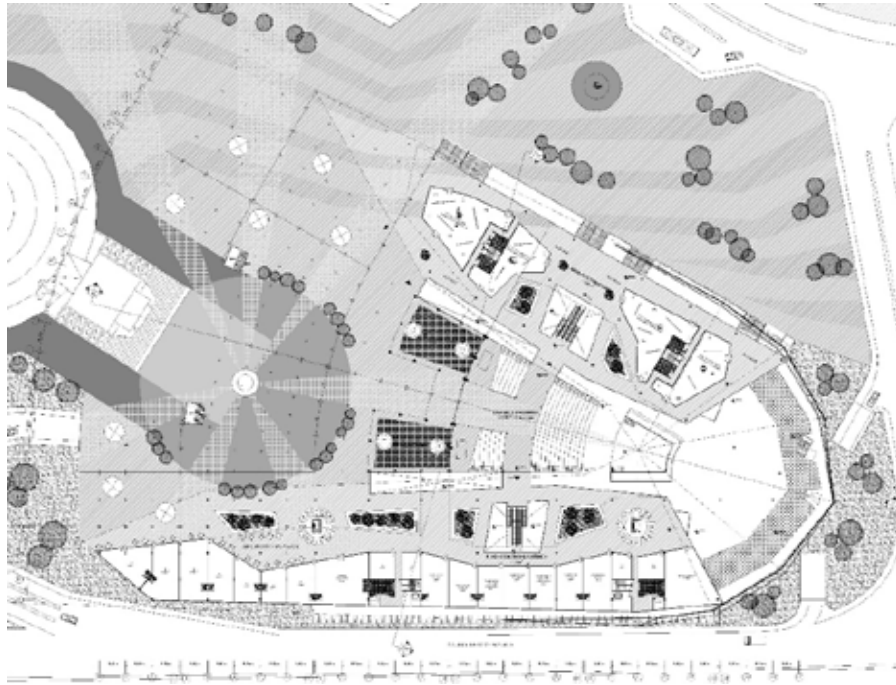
Planta Baja. Nivel ±5.40m. (2016)
